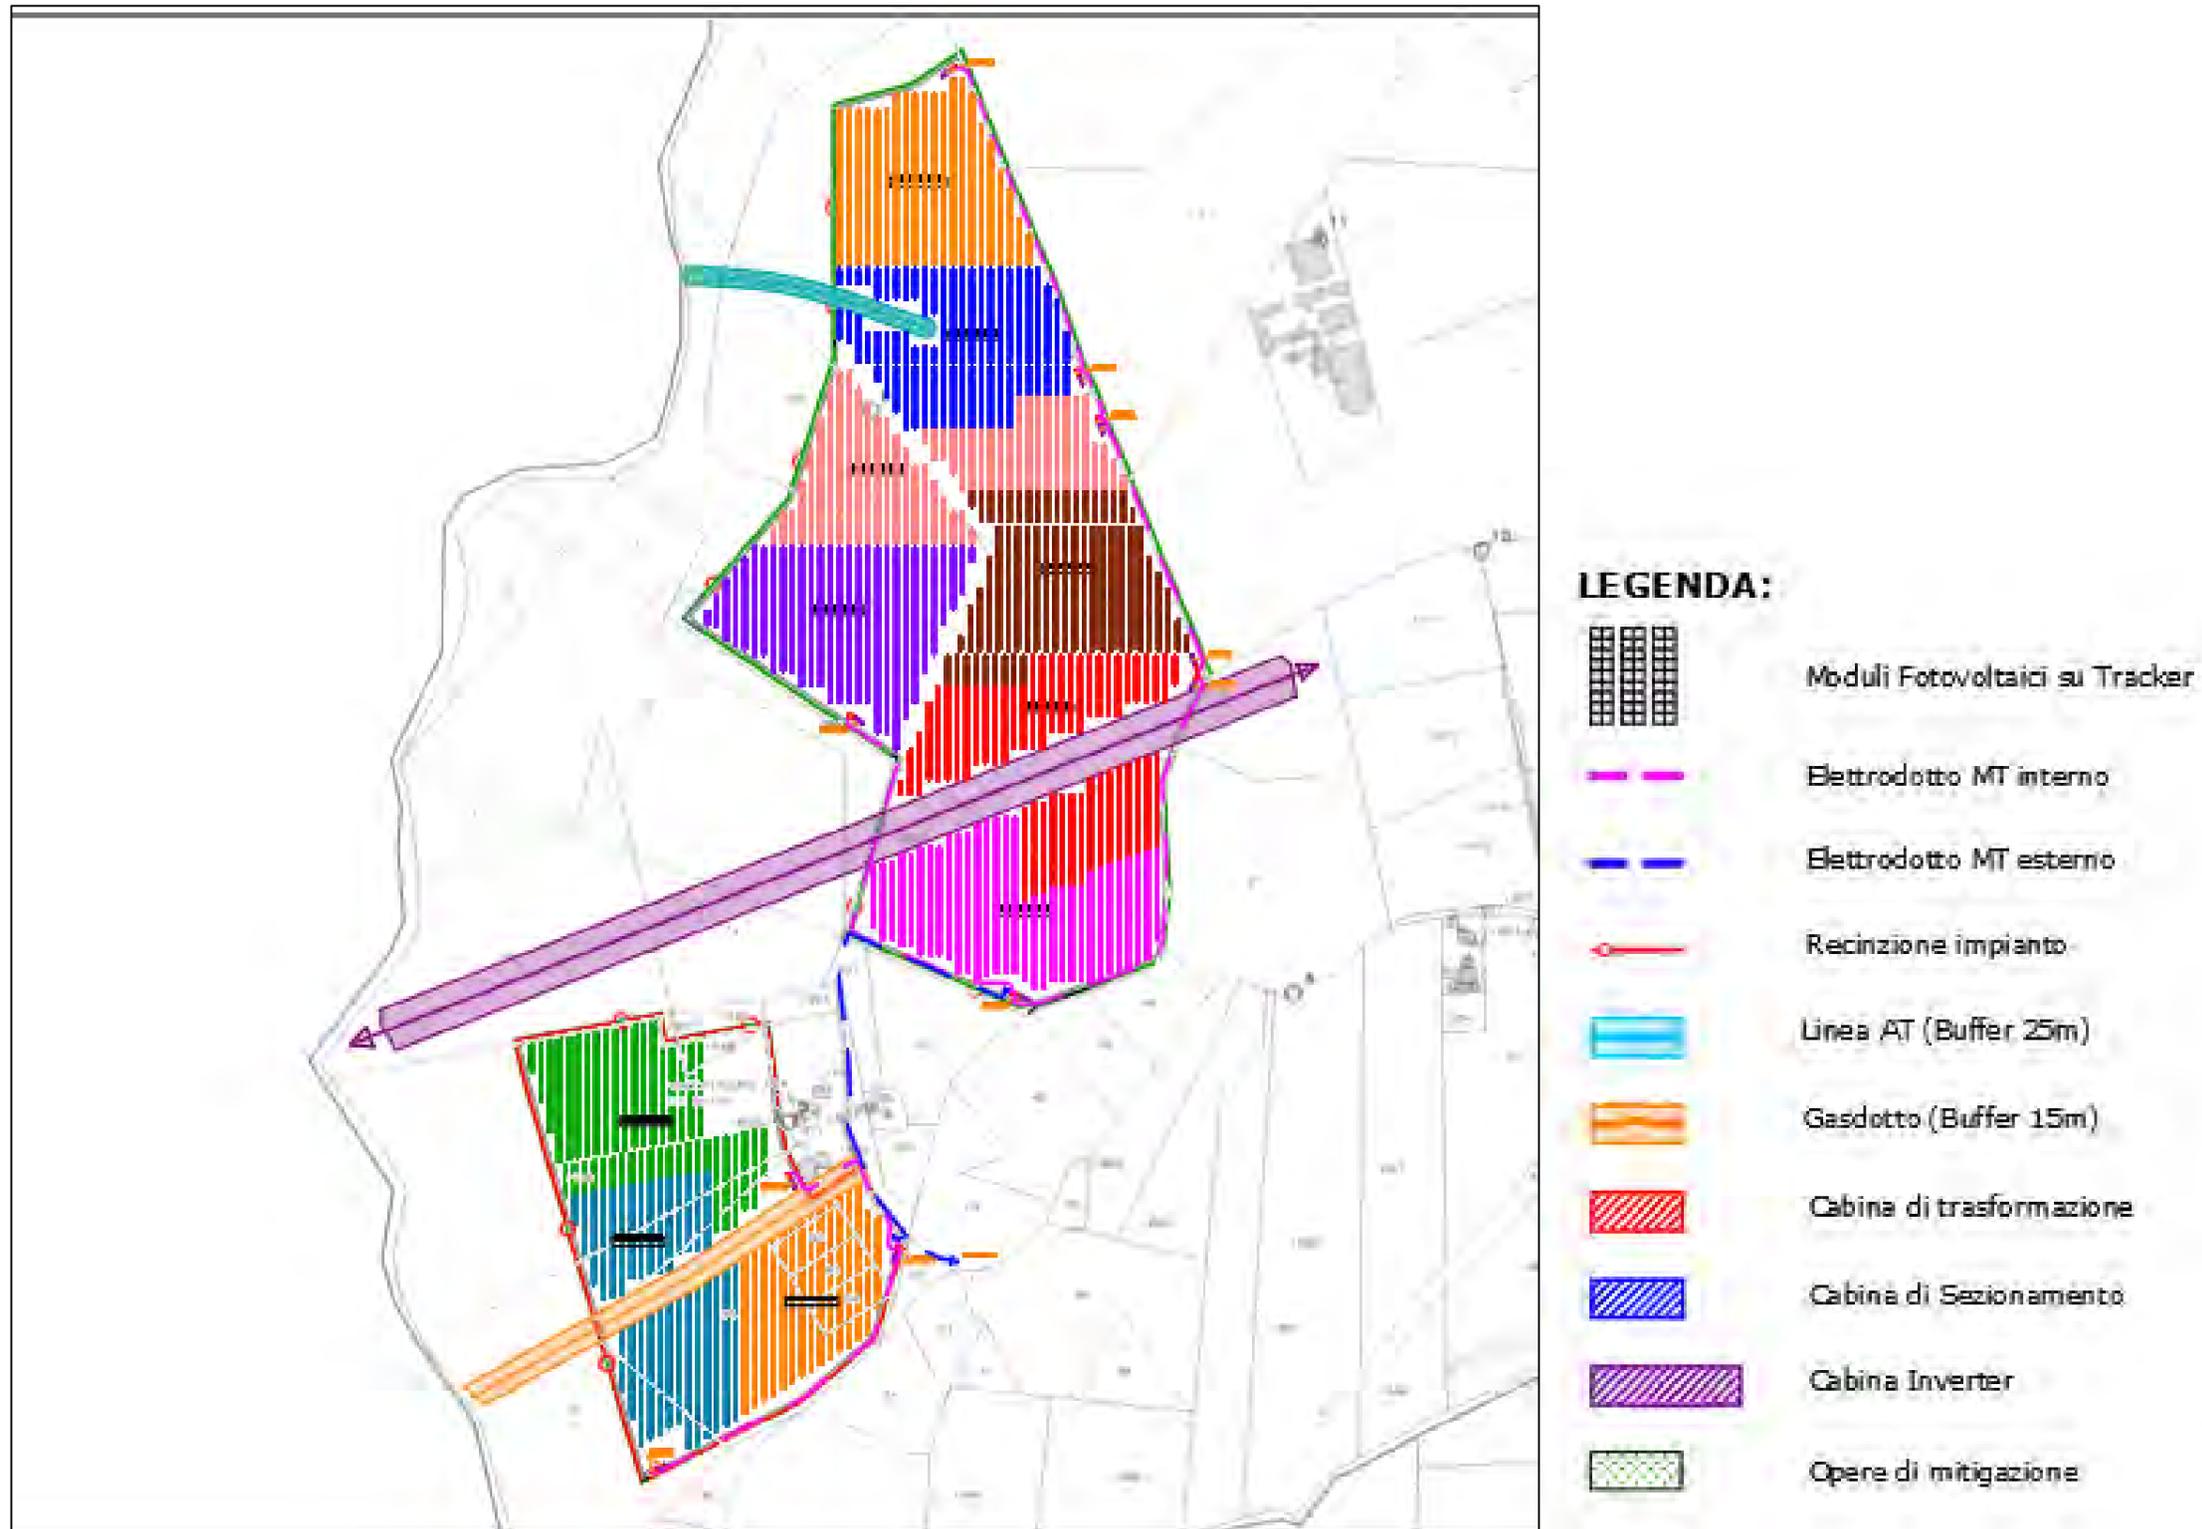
Stralcio elaborato DEF-TAV.07 – Layout impianto con sottocampi
